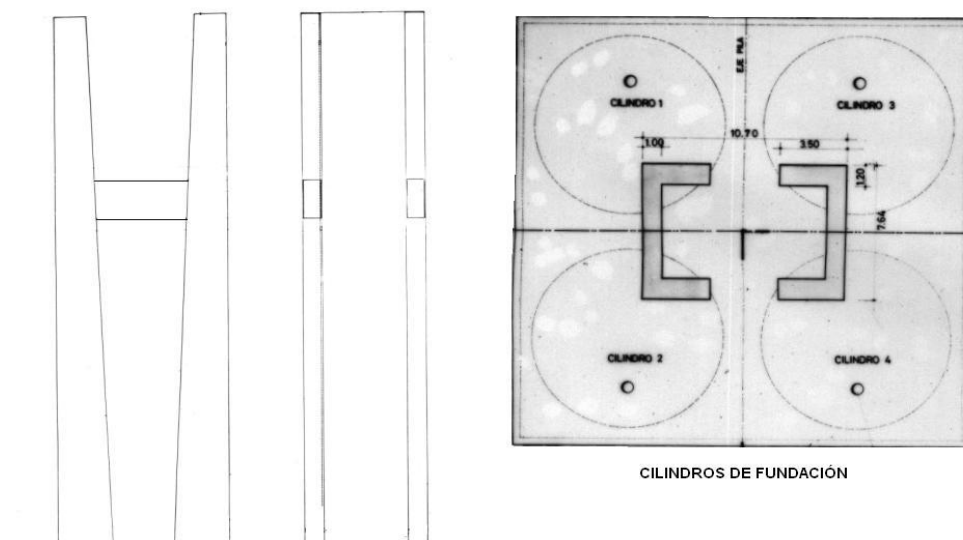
Esquema de las pilas principales del puente Libertados General San Martín.
